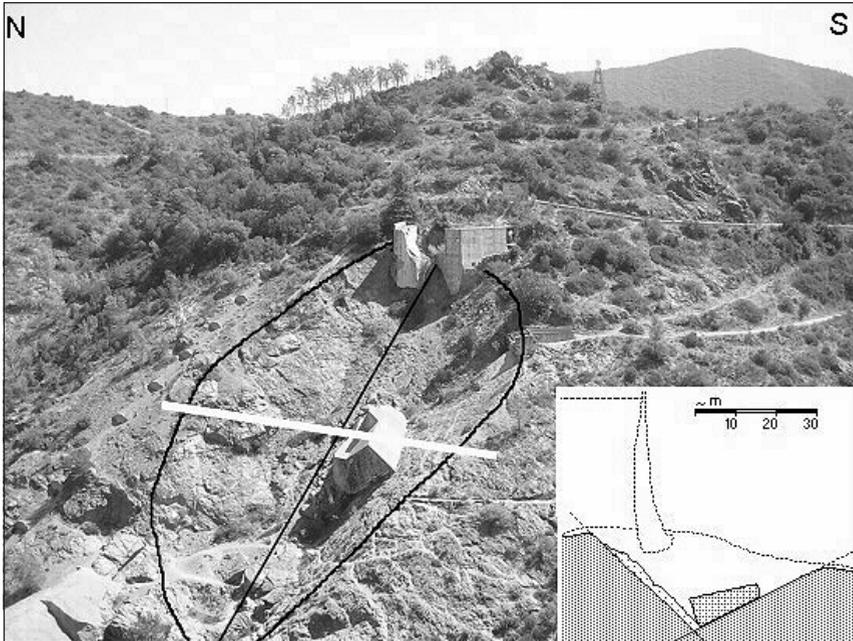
b – Le dièdre de failles de la rive gauche
